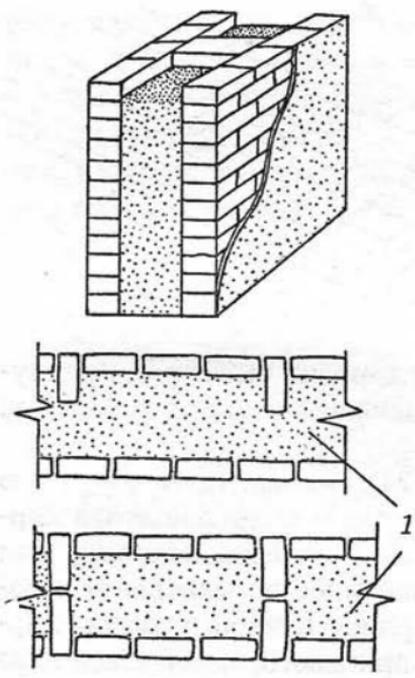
Кирпичная стена пустотной колодезной кладки:
